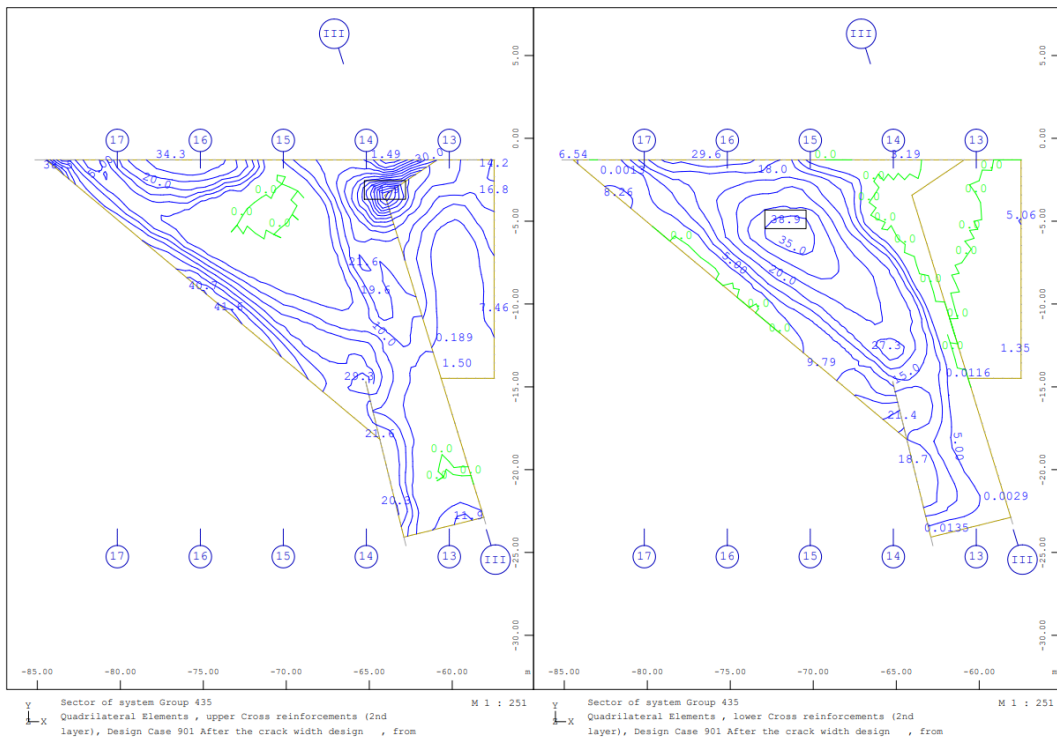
Armadura secundária na face superior (esq.) e inferior (dir.) – laje de cobertura – acesso Sul – ELS
